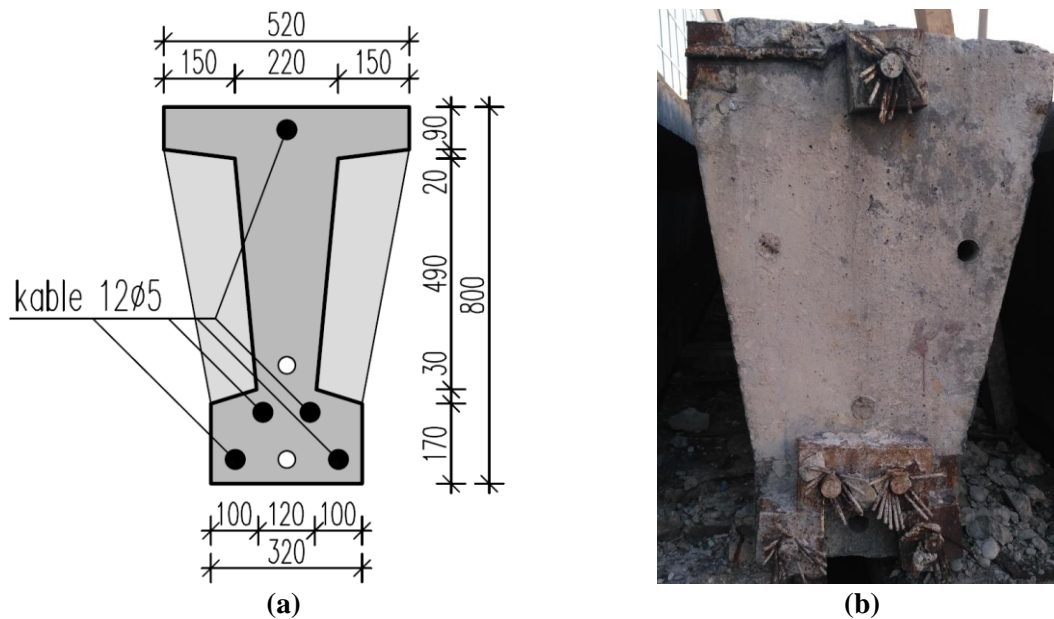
Prefabrykowane belki kablobetonowe przeznaczone do badań.
